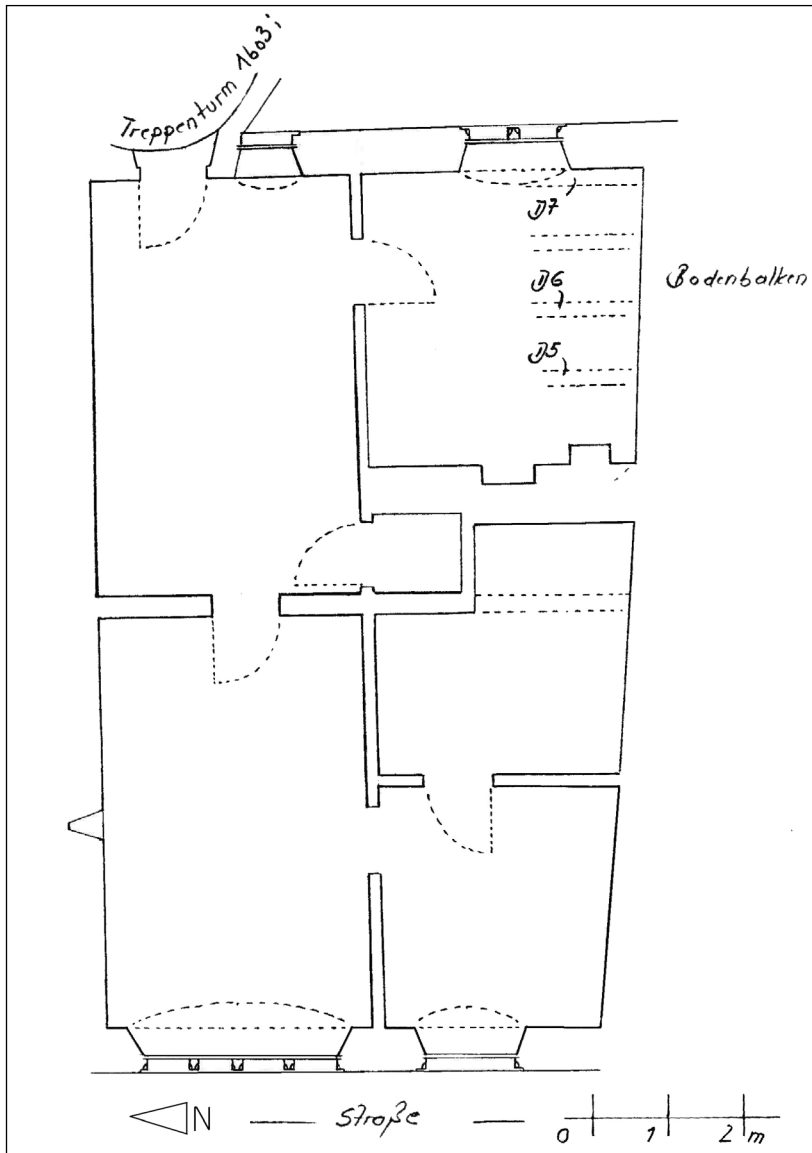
Hauptstraße 41, Grundriss 2. Obergeschoss.
